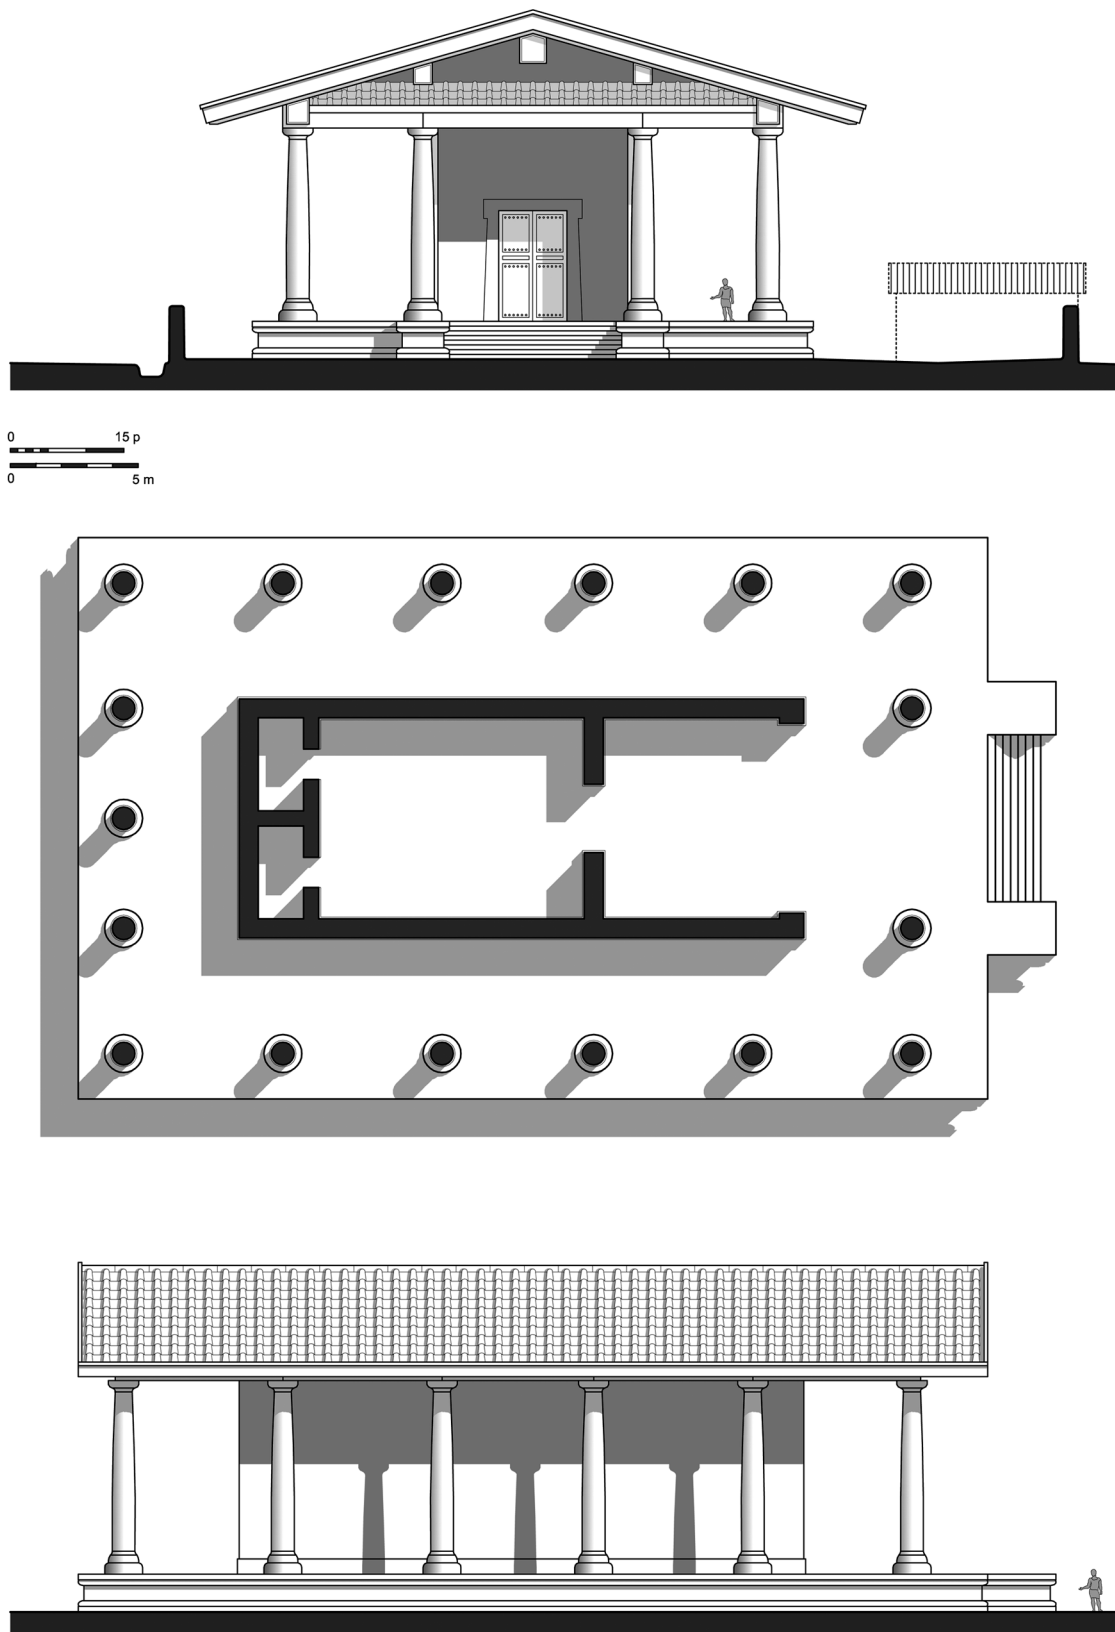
Ricostruzione del prospetto principale, della pianta e del prospetto laterale del tempio (disegni dell'autore).
